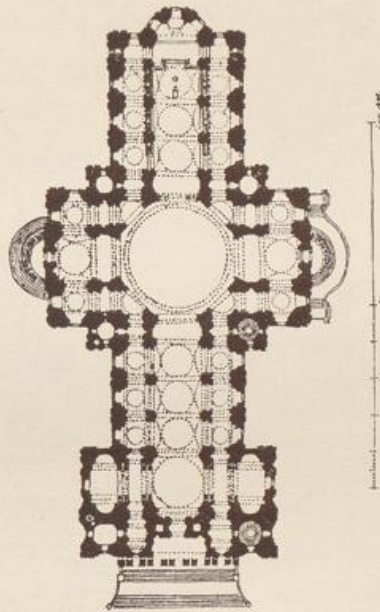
Grundriss von St. Paul in London (n. Gailhabaud).
